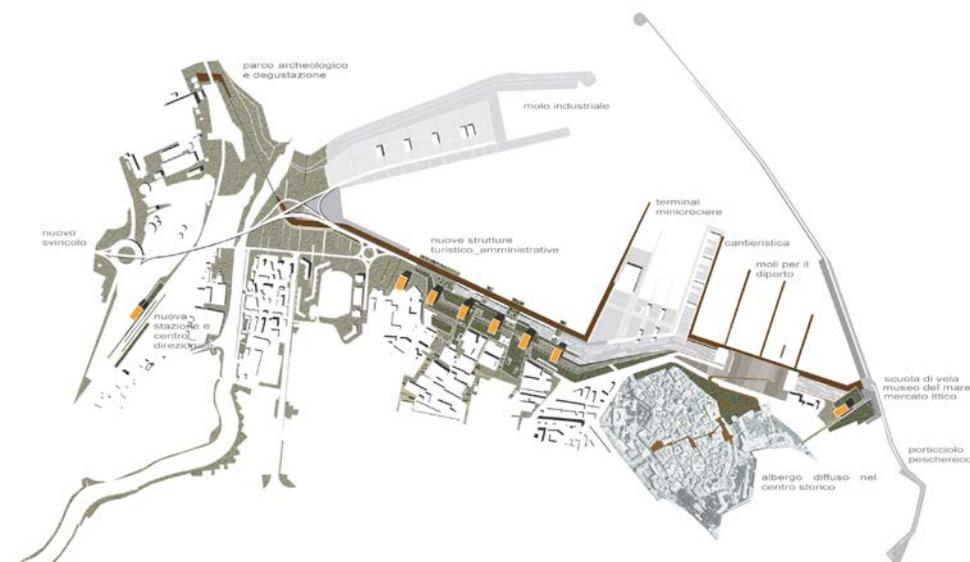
Planimetria generale. Nuova complessità e mixité funzionale, per rigenerare Crotona
